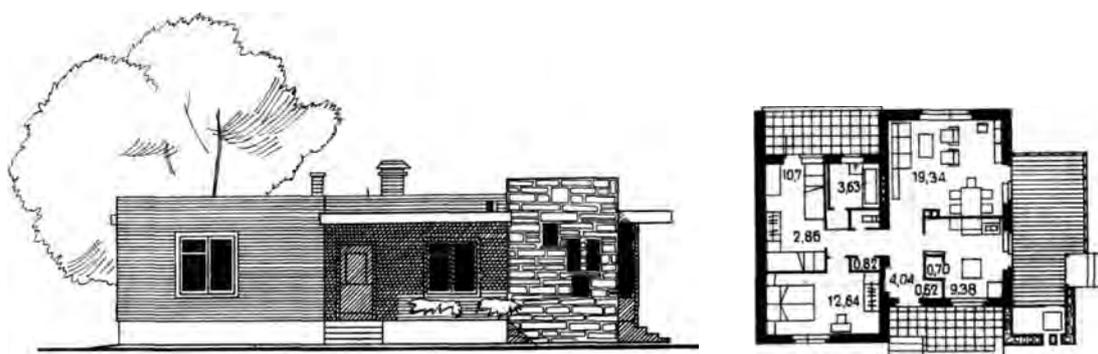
Одноквартирный одноэтажный трехкомнатный дом для южных районов. Фасад, план
